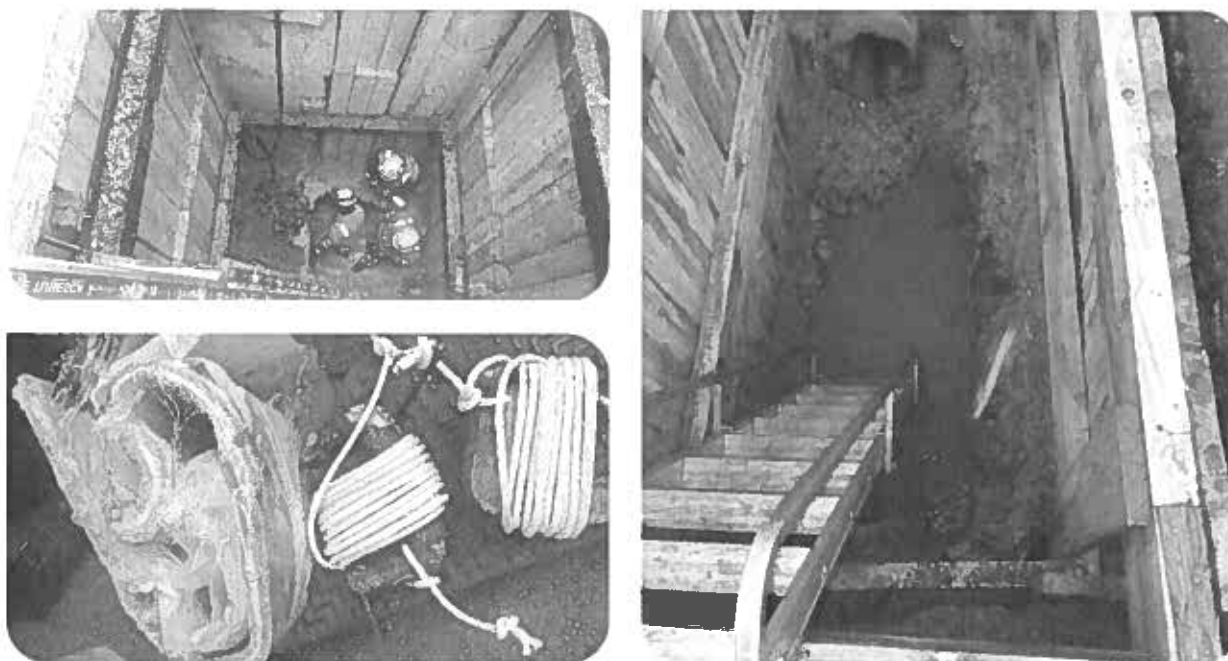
Travaux de remplacement en tranchée ouverte et gainage des réseaux d'assainissement avenue Armand Guillebaud à Antony
